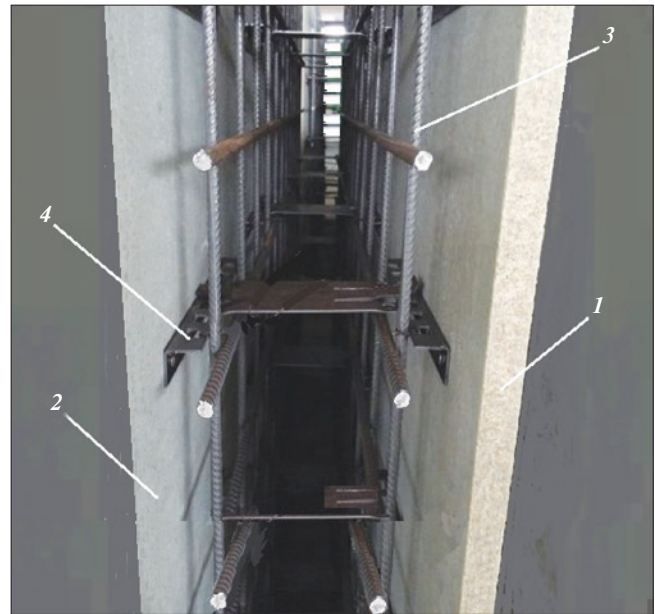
Фрагмент блока несъемной опалубки в сборе: 1 – внутренняя панель; 2 – наружная панель; 3 – арматурный каркас; 4 – стяжное устройство
